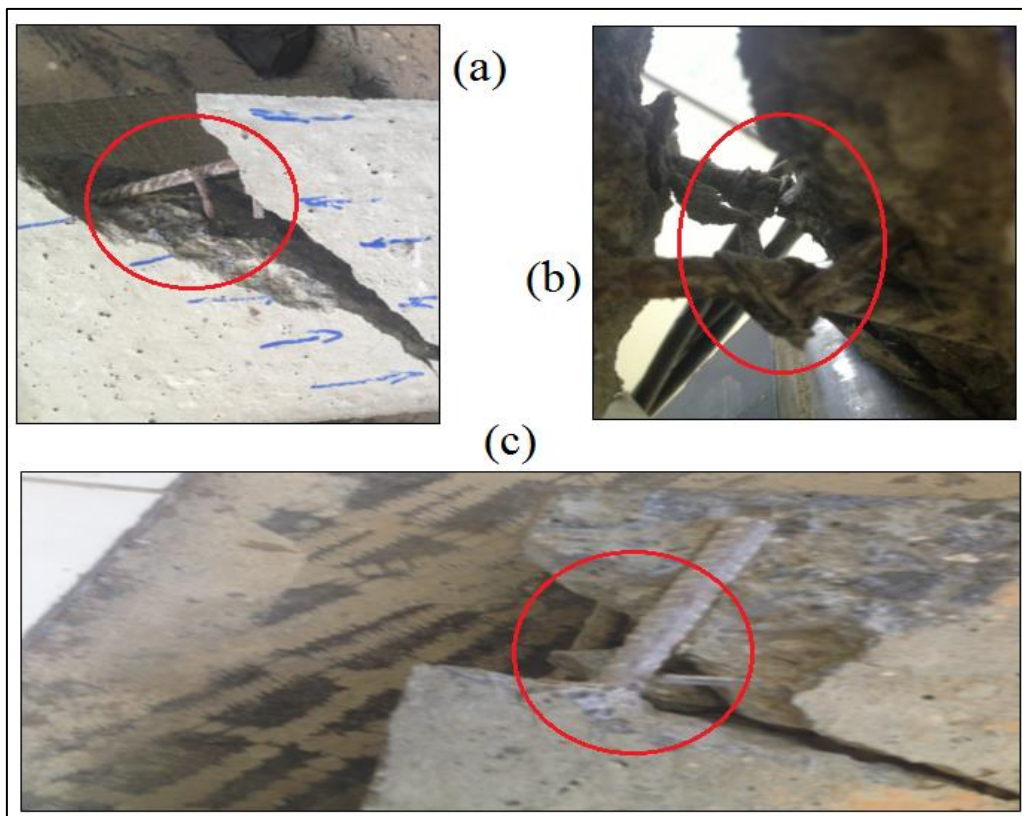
Detalhe sobre as armações soldada (a) e (c) e amarrada (b) após a ruptura da amostra.
